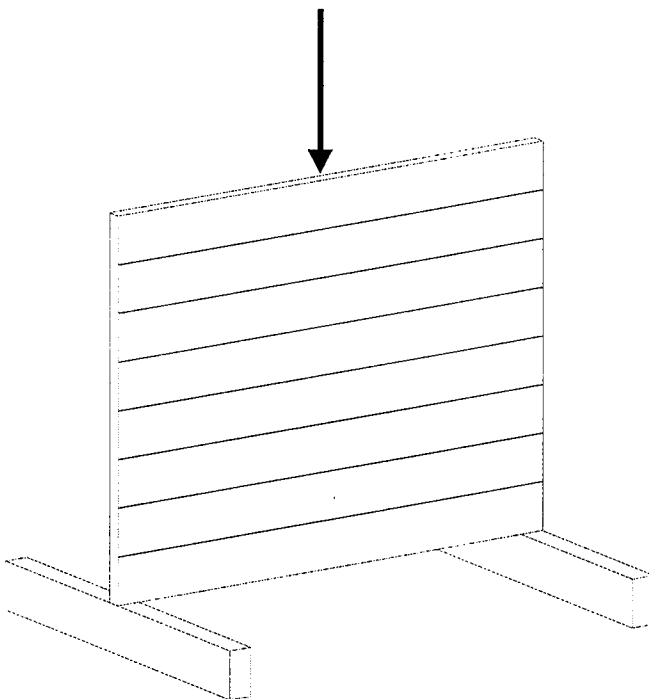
Scherung rechtwinklig zur Plattenebene (panel shear), Faserrichtung der Decklage parallel zur Spannrichtung
